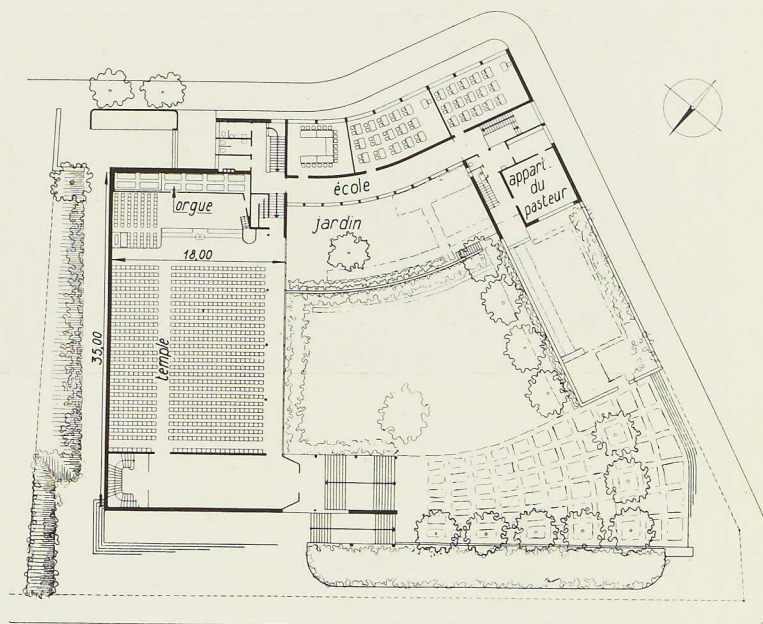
(à droite). Plan du temple et des locaux annexes.
